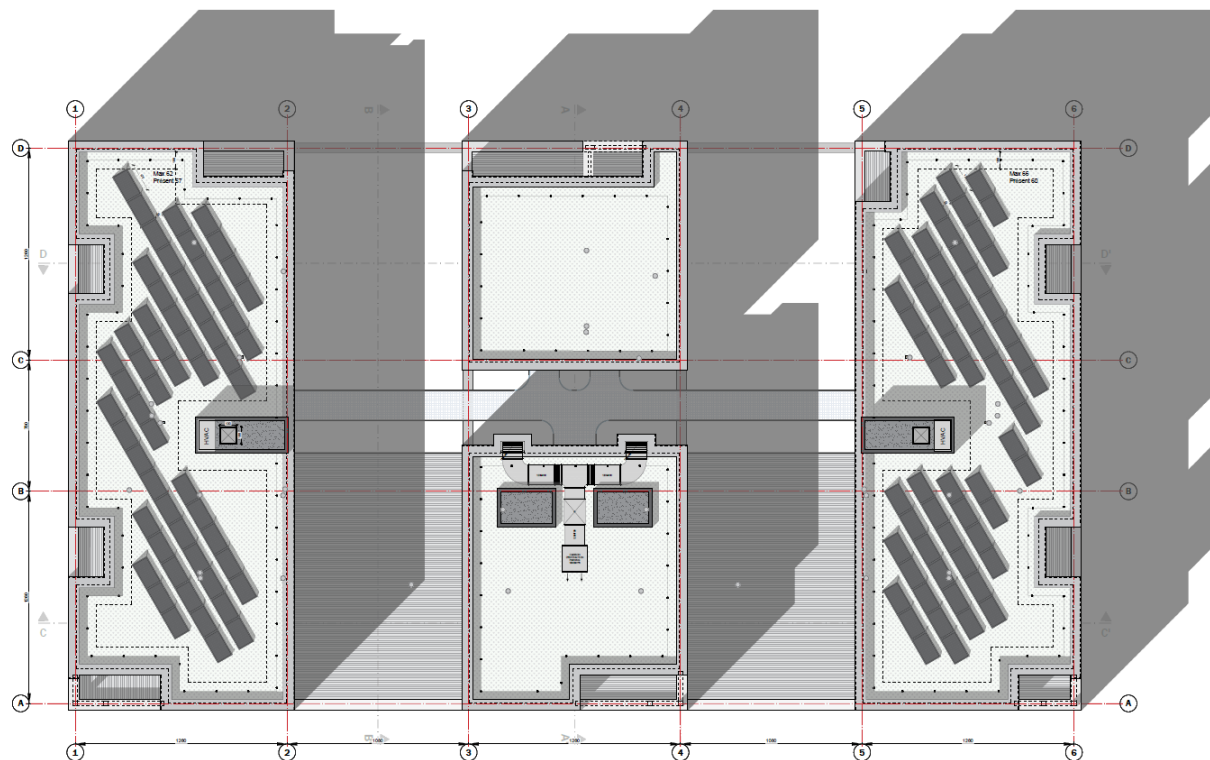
Extrait de plan de la toiture (source : ARTER Architects)
